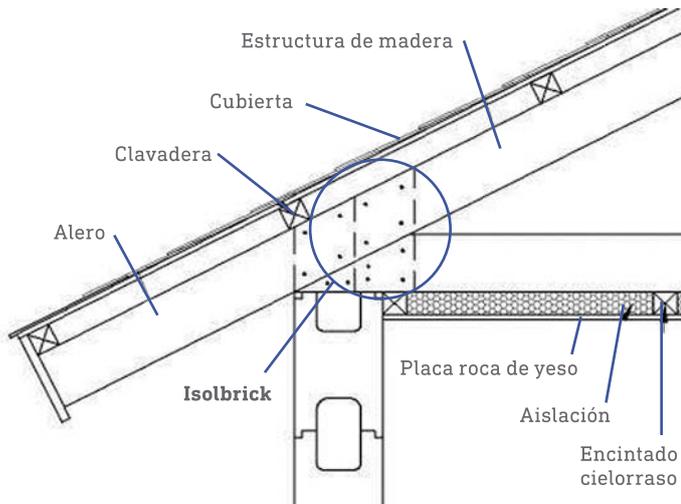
• Encastrar las vigas de madera al Isolbrick.
